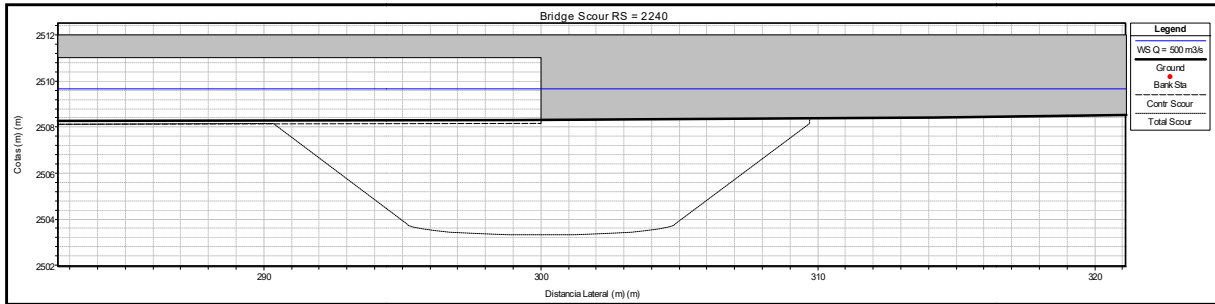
Detalle de las erosiones calculadas, por contracción + erosión local en estribo de margen derecha (MD)
